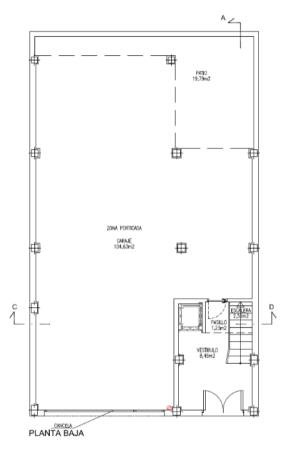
Distribución planta baja. 2012. Muñoz Antonino
